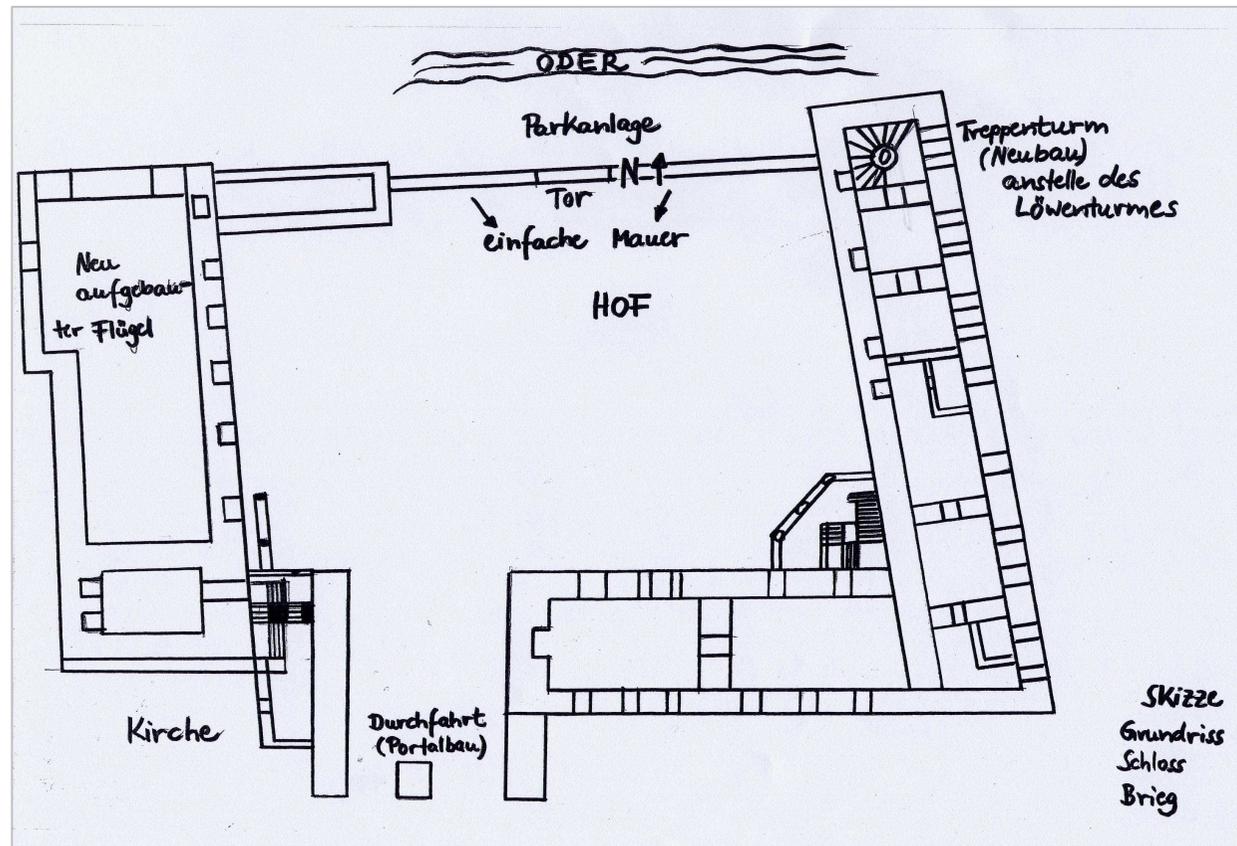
Grundriss Schloss Brieg (Skizze)
